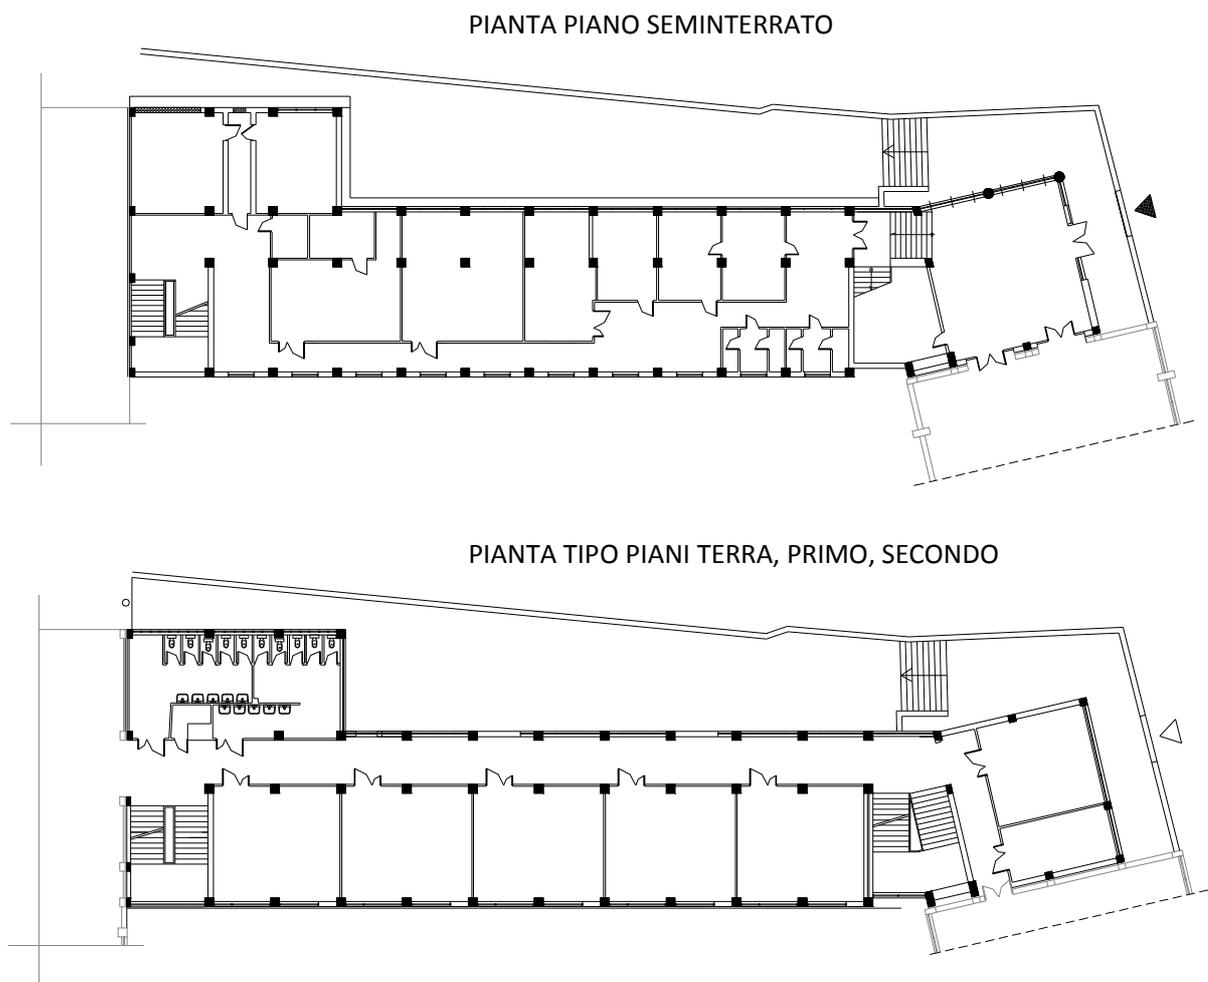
1: Piante tipo dei vari piani, indicazione della struttura.
